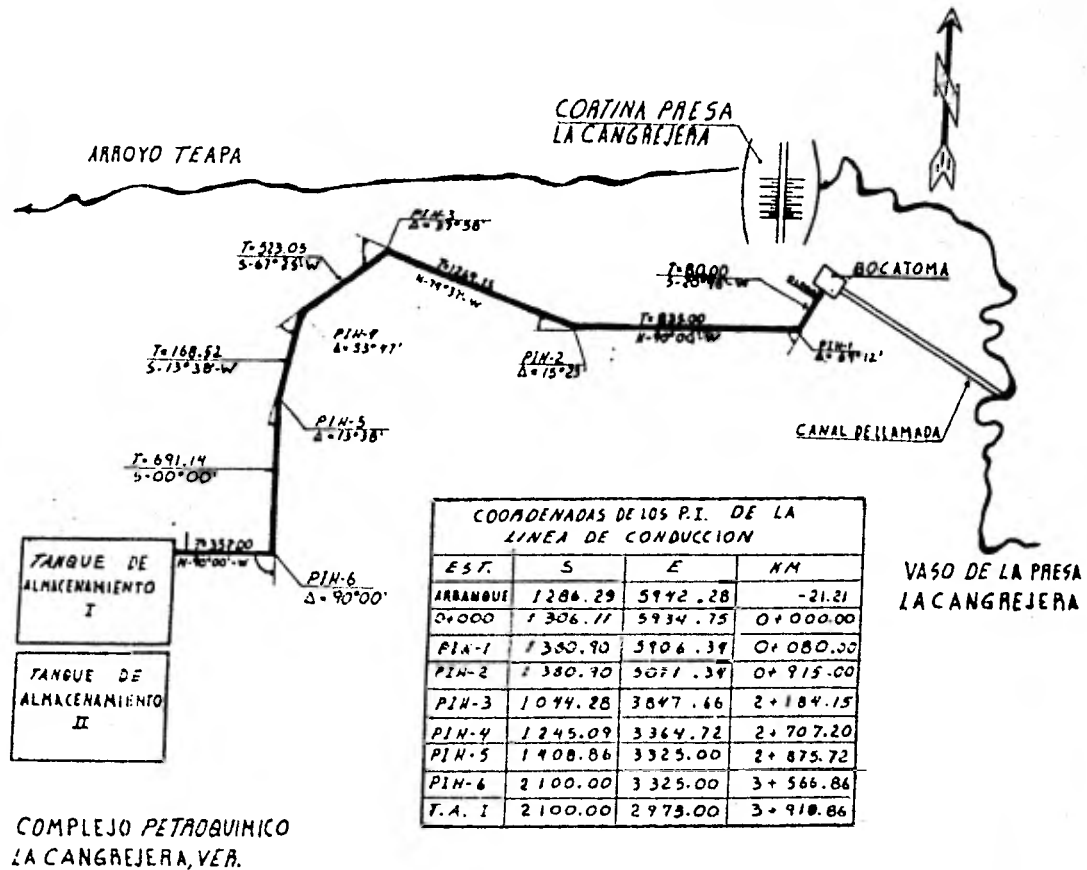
CROQUIS DE LOCALIZACION PLANTA
